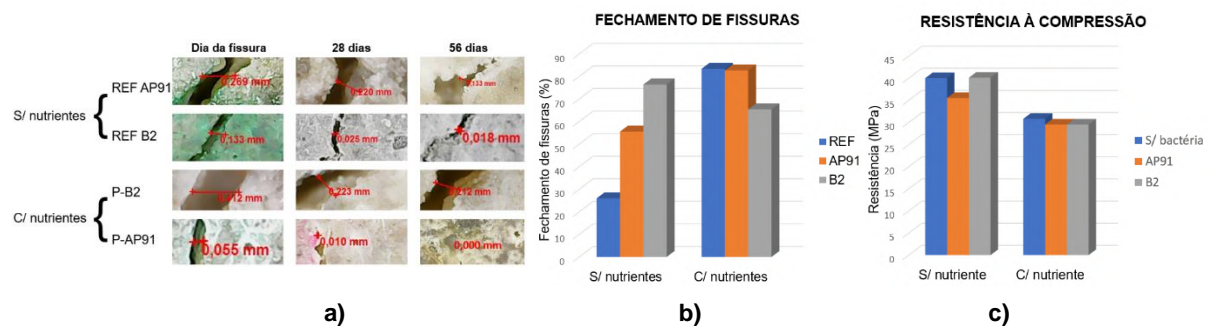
a) Detalhe das fissuras; b) fechamento das fissuras; c) resistência à compressão.
